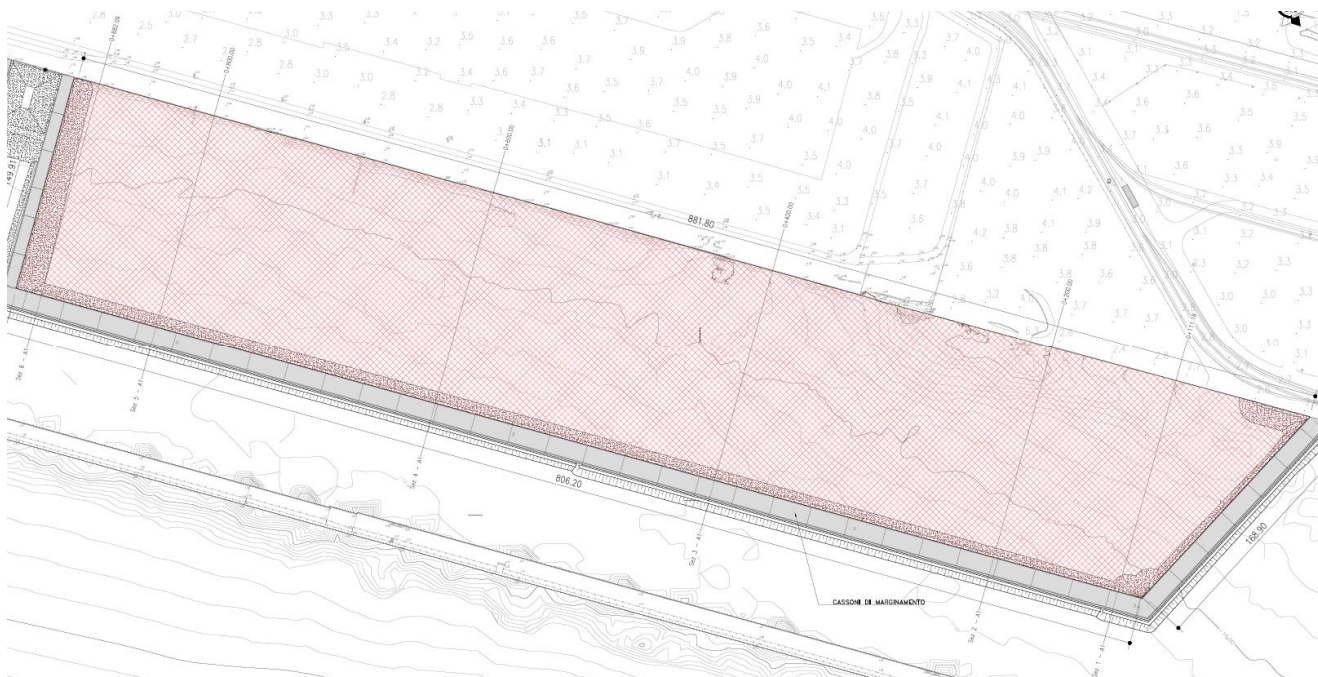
Vasca A1 Stralcio Planimetrico con individuazione dell'area interessata dalla posa in opera della geomembrana HDPE +geotessile tessuto non tessuto
